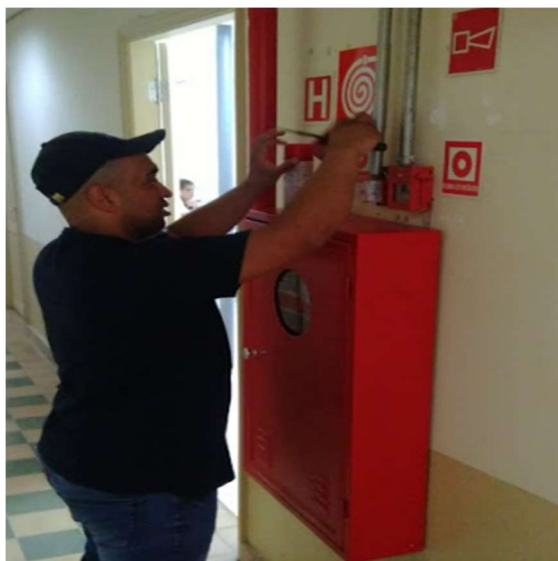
Conservação equipamentos / sistema combate ao incêndio.
